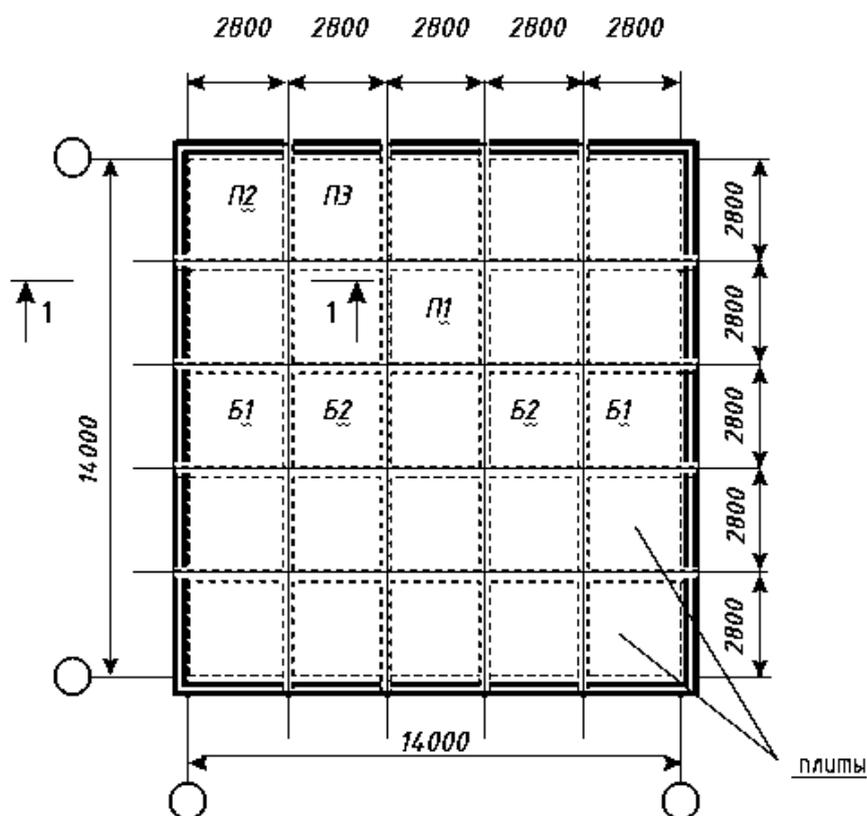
Вид монолитного кессонного перекрытия в плане.
